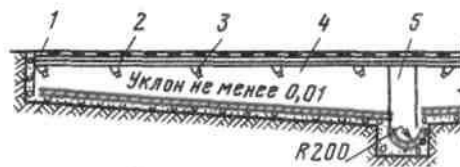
Схема навозоприемного канала с напорным трубопроводом и насадками: 1 – решетка; 2 – смывная труба; 3 – насадка; 4 – навозоприемный канал; 5 – поперечный канал.
